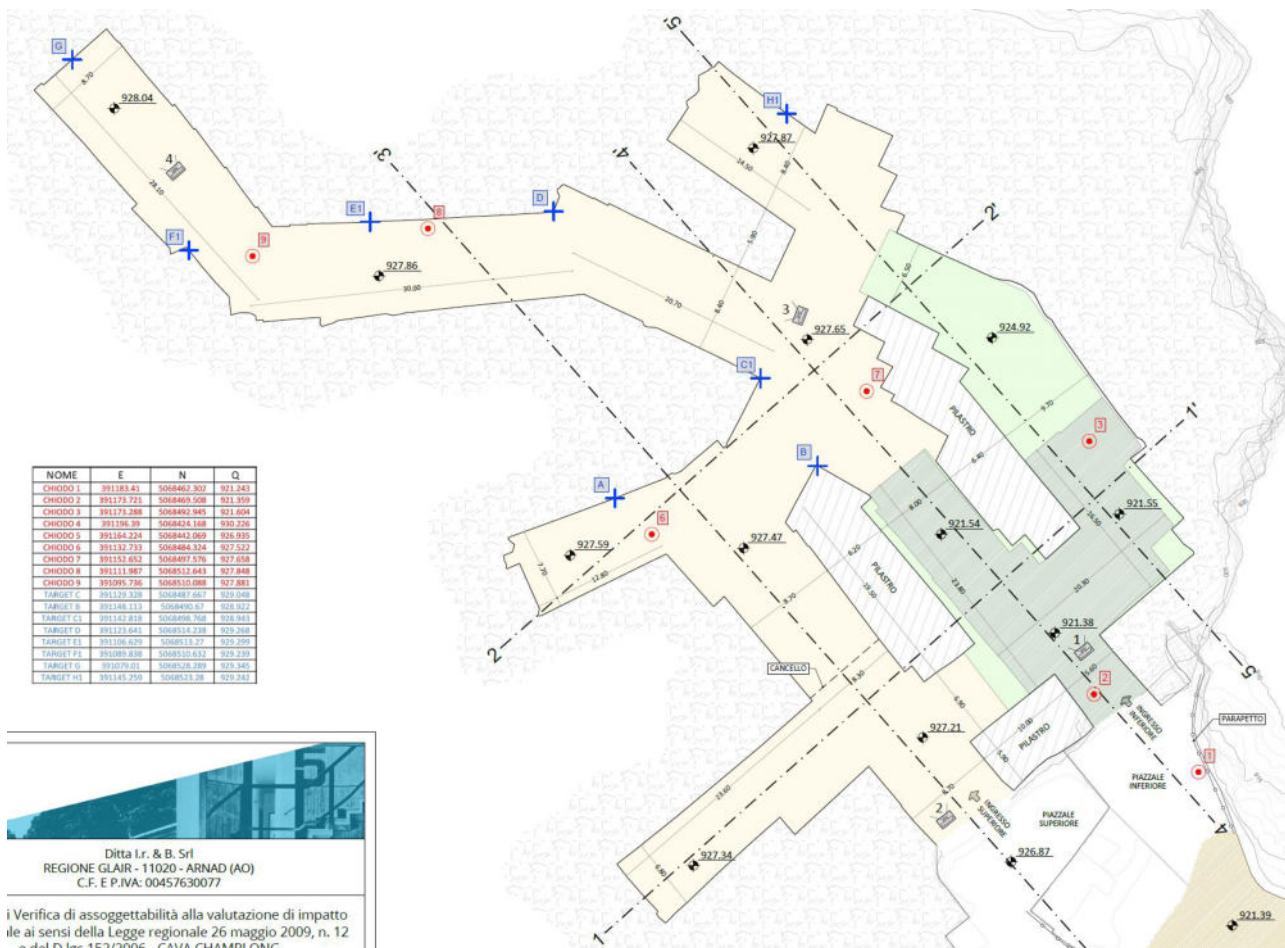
Stralci di planimetria di rilievo delle gallerie di coltivazione.
